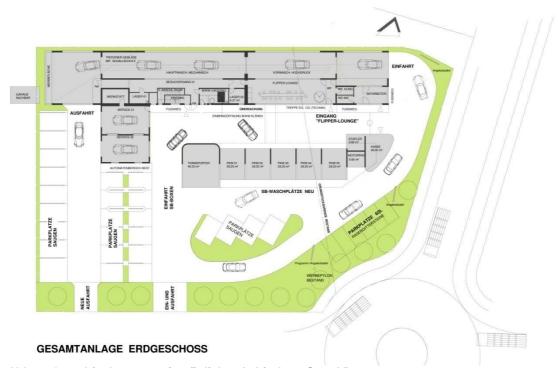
Grundrisskonzept mit möglicher Anbindung Stand Dez. 2010
